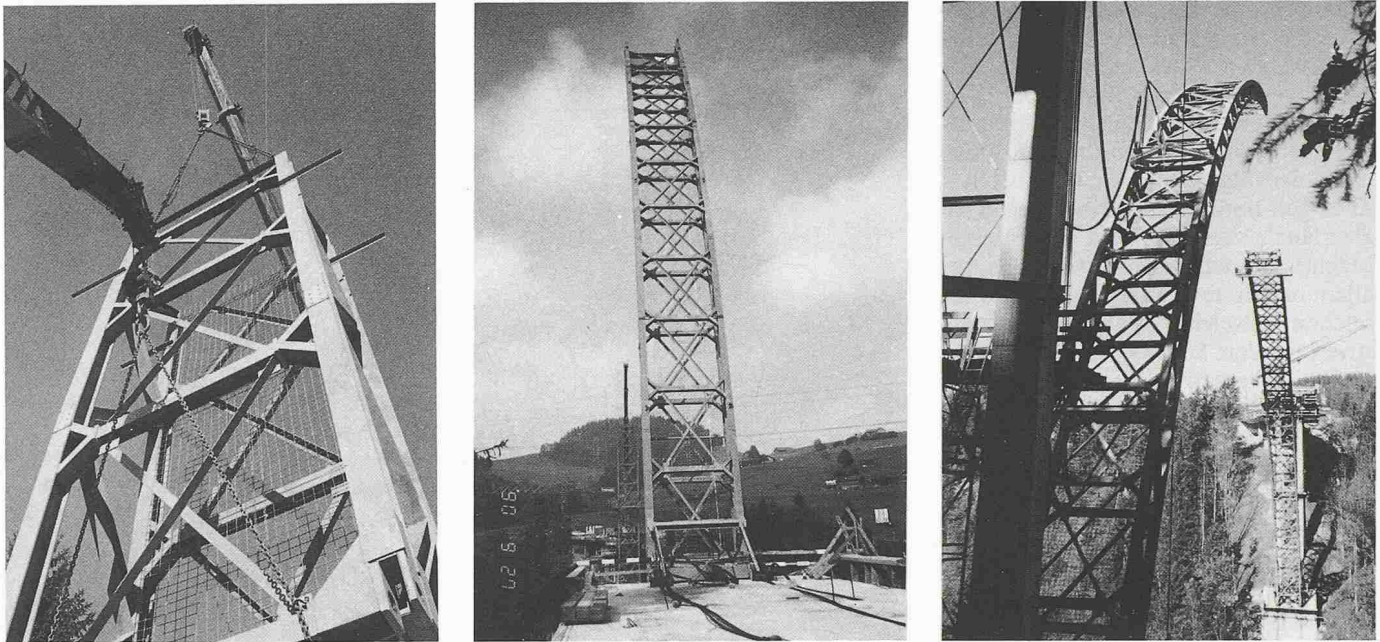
Aufrichten und Einklappen der Stahlkonstruktion
